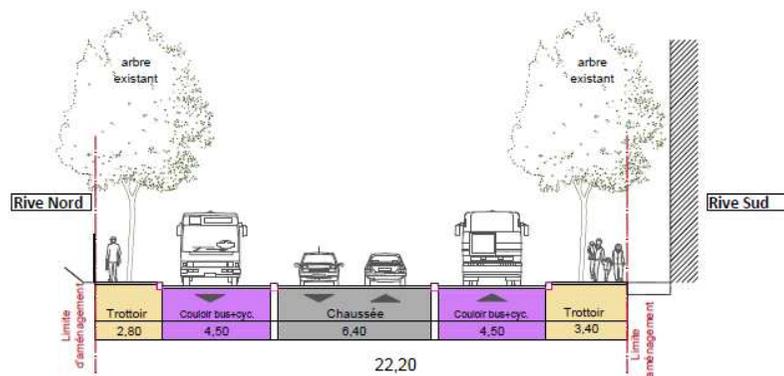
Coupe type en section courante sur le boulevard Léon Feix, à l'ouest de la rue Michelet
